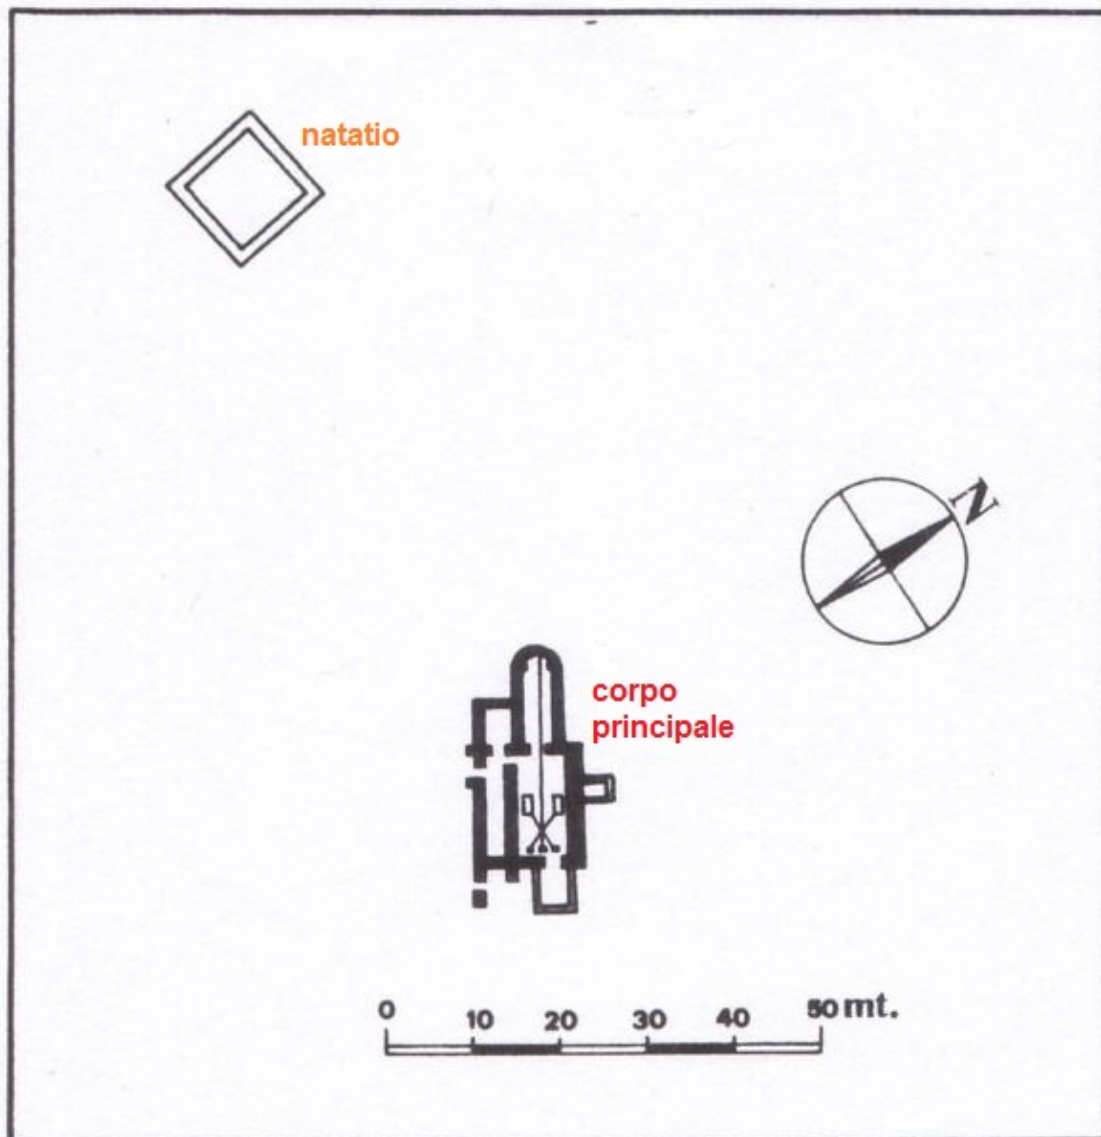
Planimetria delle terme romane (rielaborazione di M. G. Arru da ZUCCA 1987, Tav. 27, p. 258).
